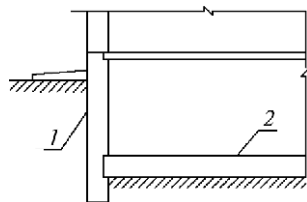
Конструктивная схема подземной части с несущими наружными стенами:
